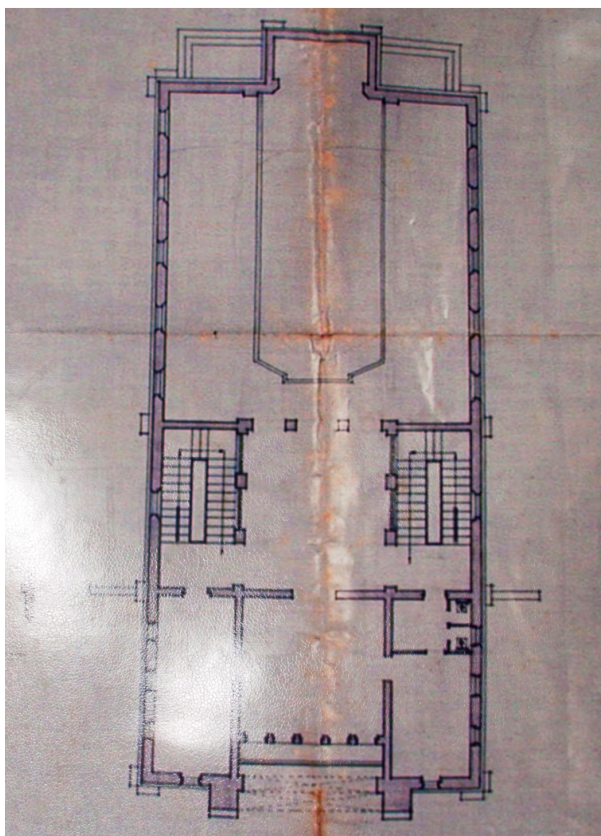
Sinagoga Mekor Haim (Porto): Planta
